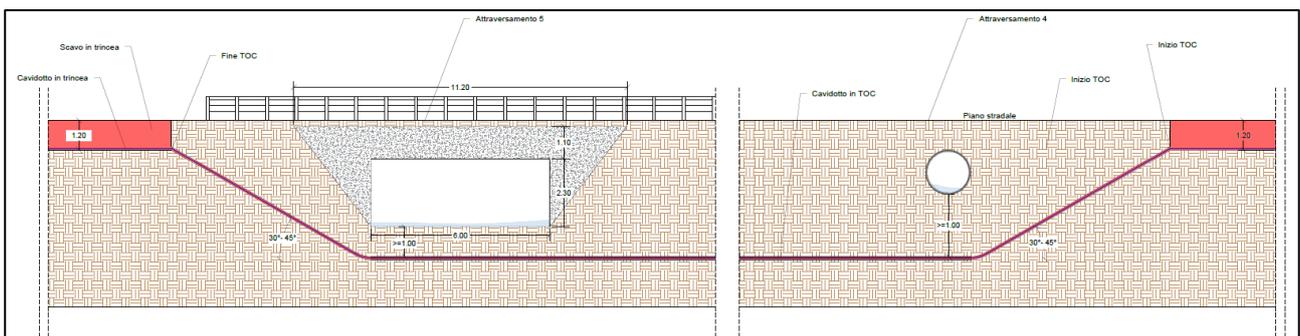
Sezione tipologica attraversamenti idraulici n.4 e 5
